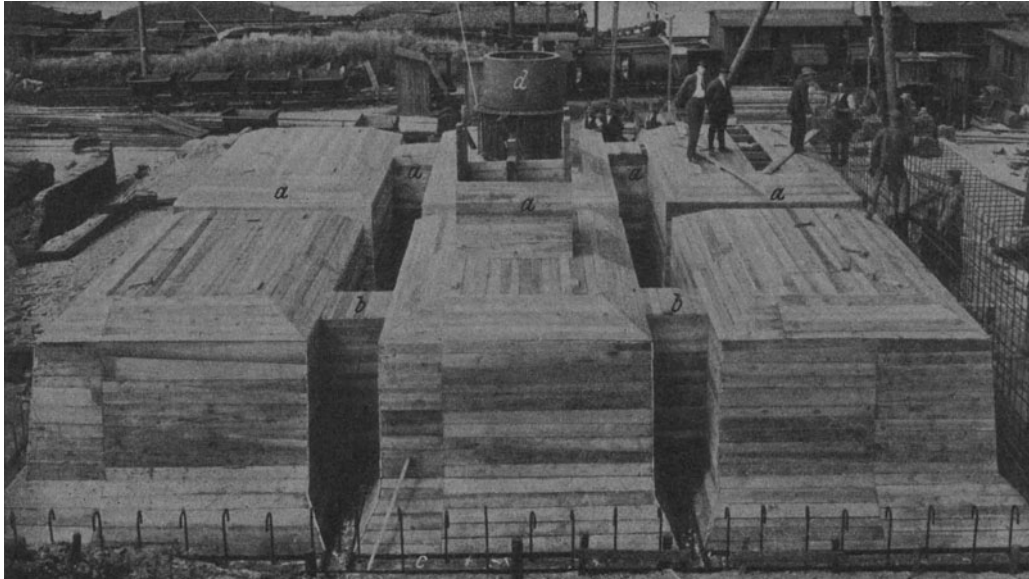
b. Innenschalung für einen Eisenbetondruckkasten mit Querwänden. (Siemens-Bau-Union.)
